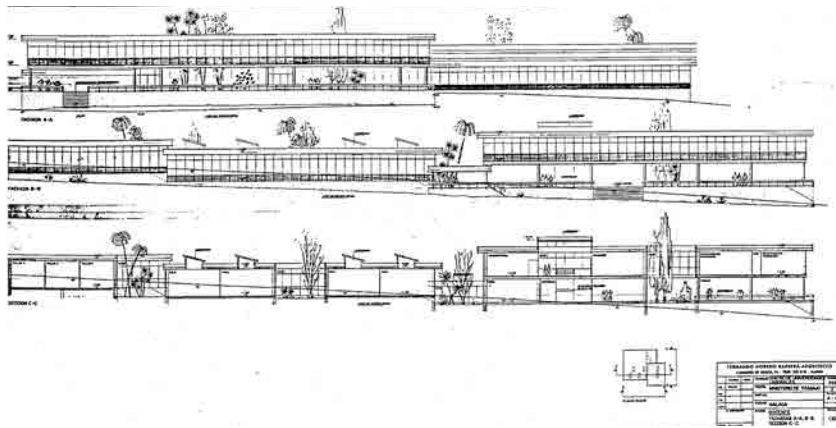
, Fig. 90 y Fig. 91 Propuesta previa: edificio docente. Alzado de la fachada Sureste (arriba), alzado de la fachada Suroeste (centro) y sección longitudinal (abajo).
